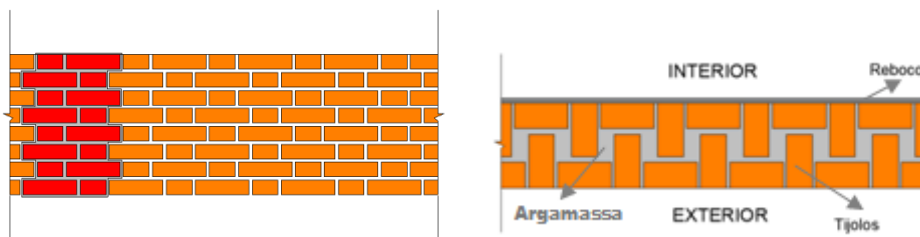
Padrão predominante de arranjo dos tijolos nas fachadas. Alçado (esquerda) e planta (direita).
